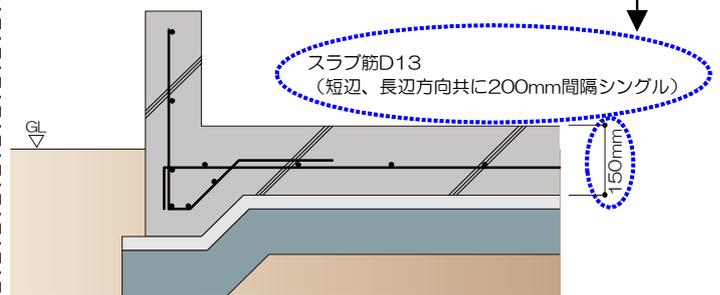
設計施工基準「べた基礎配筋表」を用いたスラブ配筋の選択例
